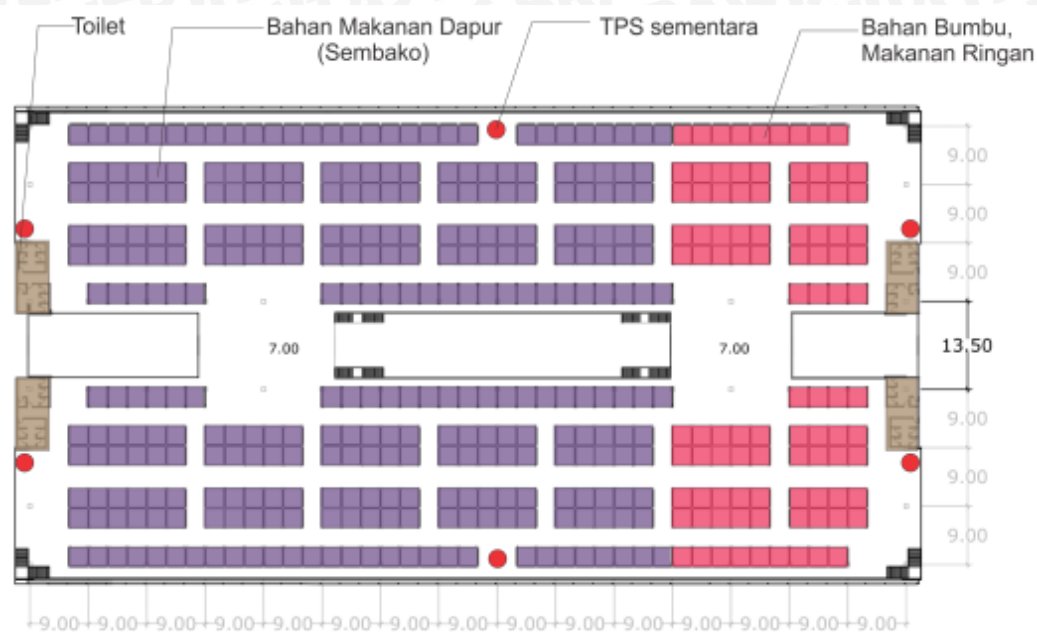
Zoning Komoditas dagang pada lantai Basement II
